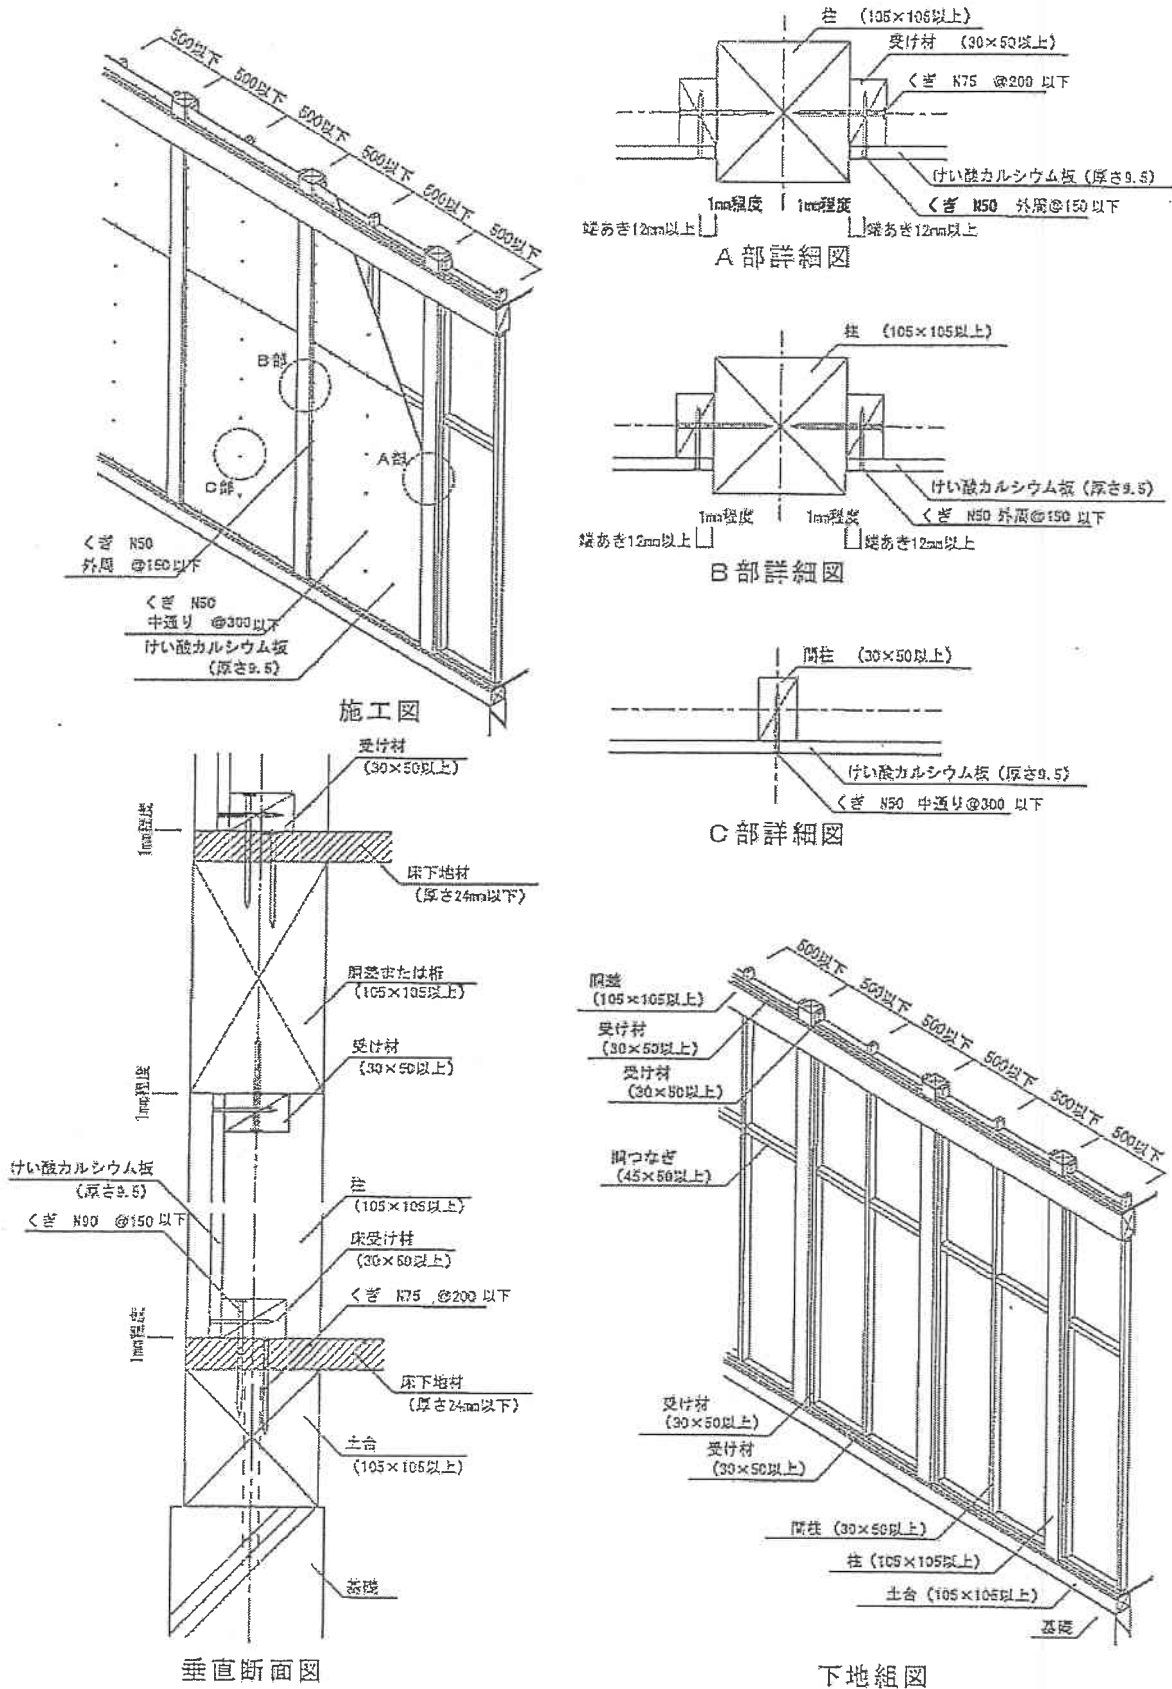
施工図：柱間隔1Pの場合 (寸法単位：mm)
